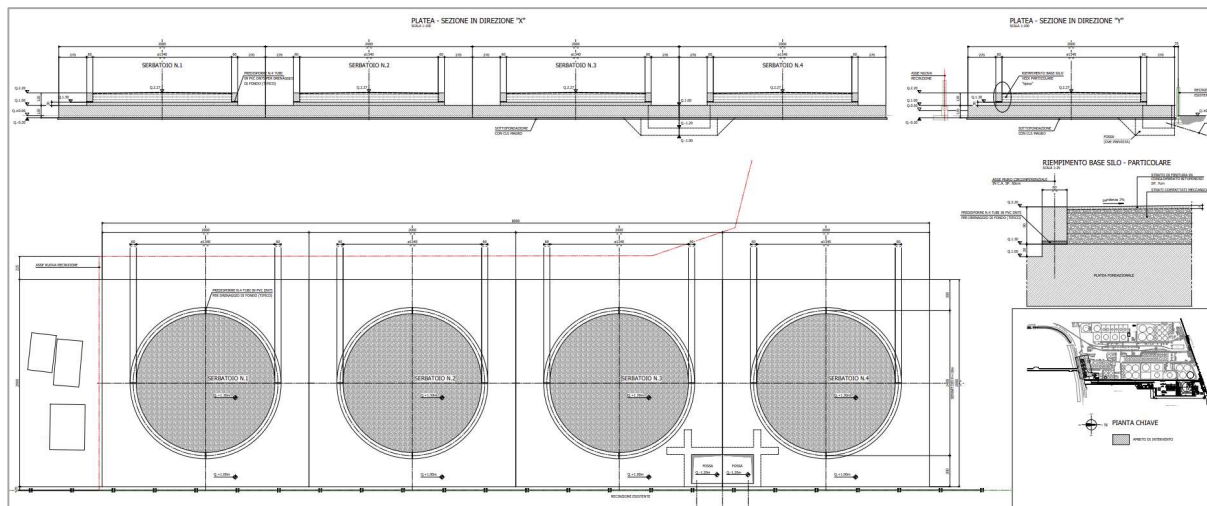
Estratto progetto fondazioni serbatoi di accumulo
